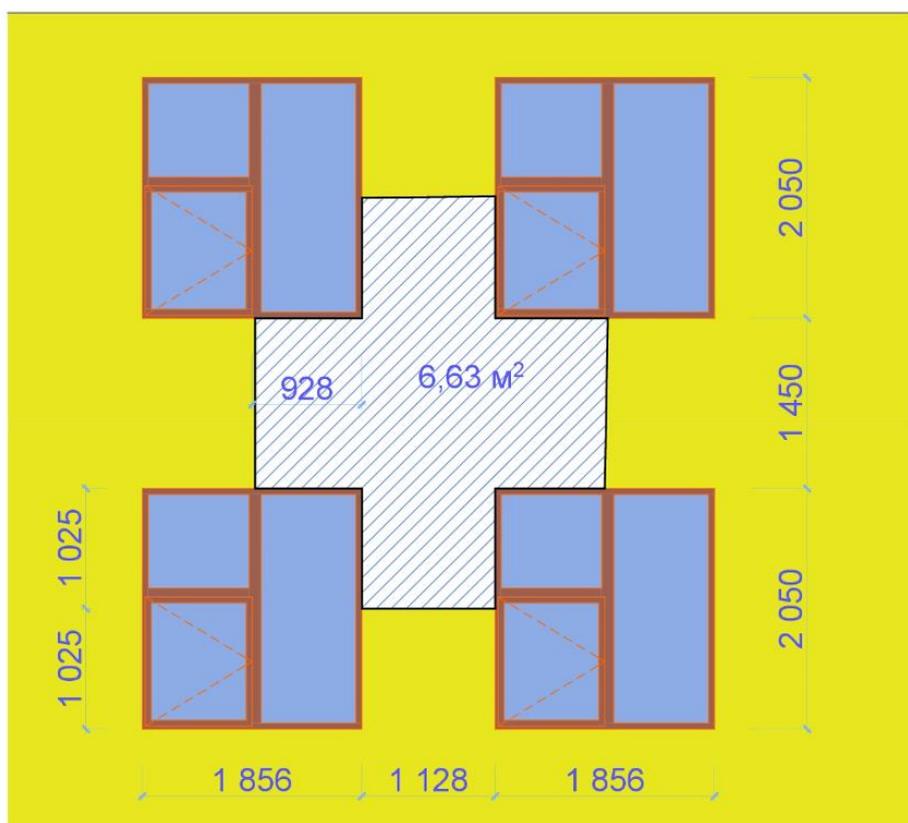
Фрагмент фасаду з розрахунковою ділянкою
